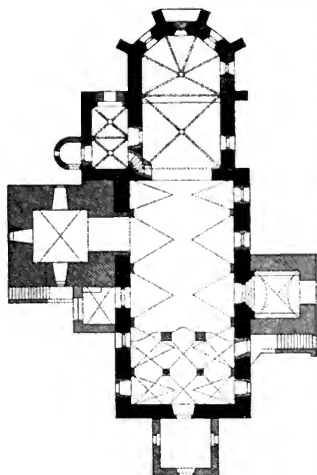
Veselí. Grundriss der Kirche.
